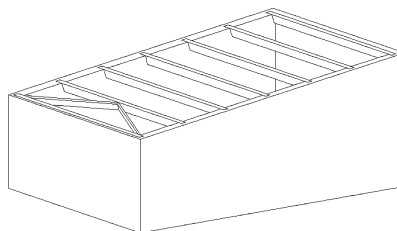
Cubierta a la molinera de entramado pesado. Detalle constructivo para disminuir la deformación en correa.
